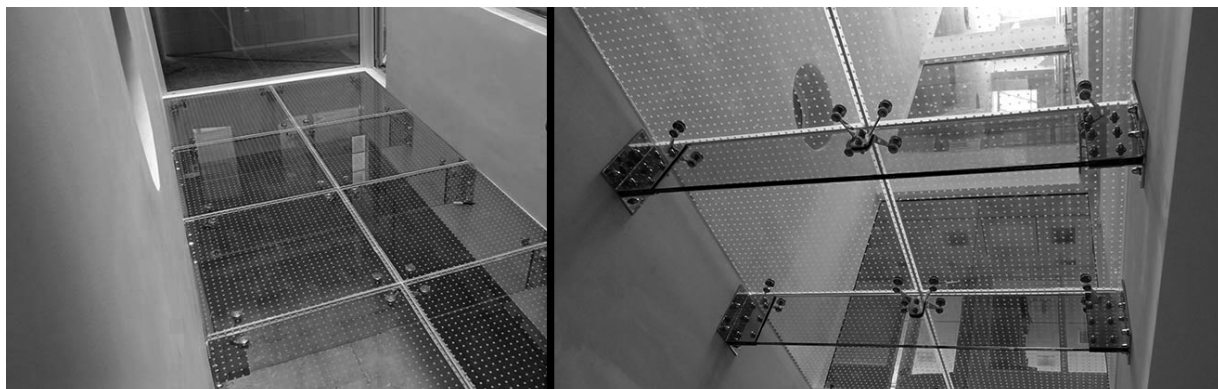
Перекрытие коридора по стеклянным балкам GLASSCON GmbH
